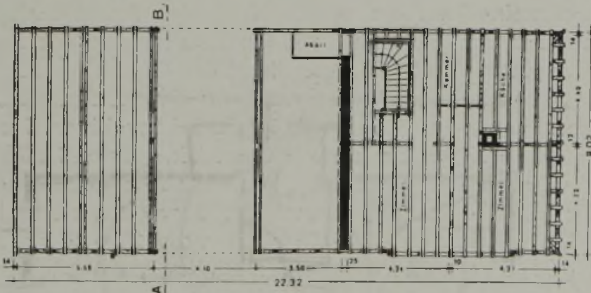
Das Erdgeschoß zu Abb. 11. Ueber der Wohnung, dem Barn und über dem Stall und der Futterkammer ist je das Dachgebälk mit eingezeichnet.
